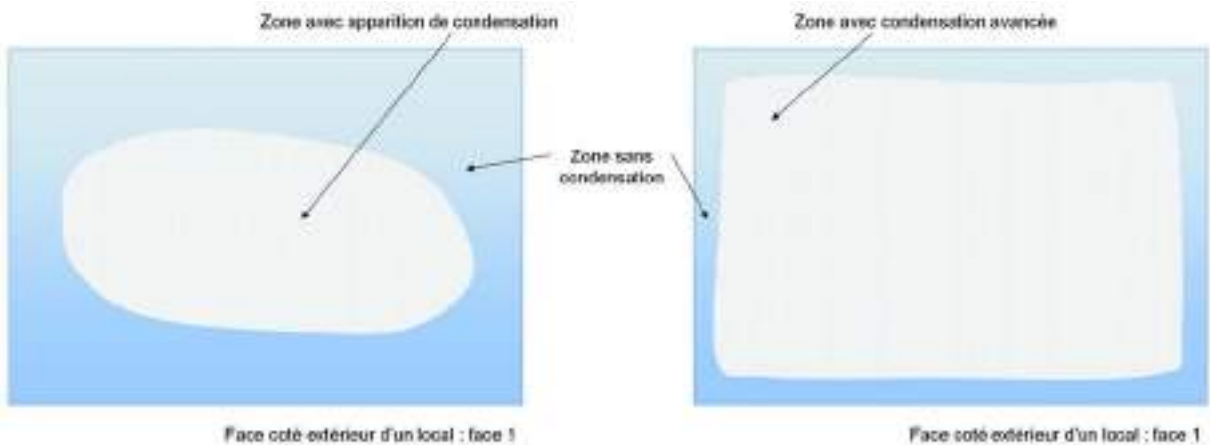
Condensation sur la face d'un vitrage côté extérieur d'un local.
